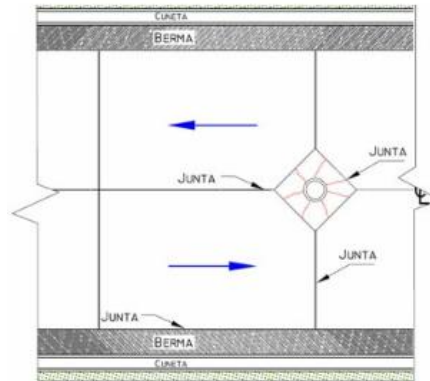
Grietas en pozos y sumideros (GA)
